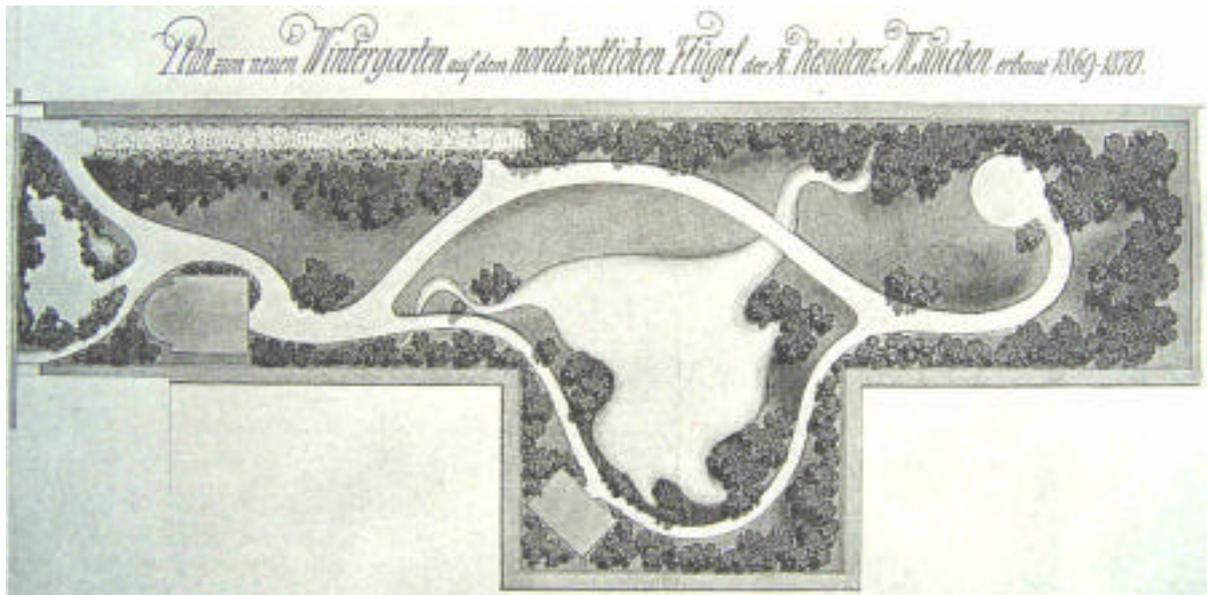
Ausgeführter Grundriss des Wintergartens Ludwigs II. nach Entwurf von Carl Effner (Evers 1986, Abb. 81)
